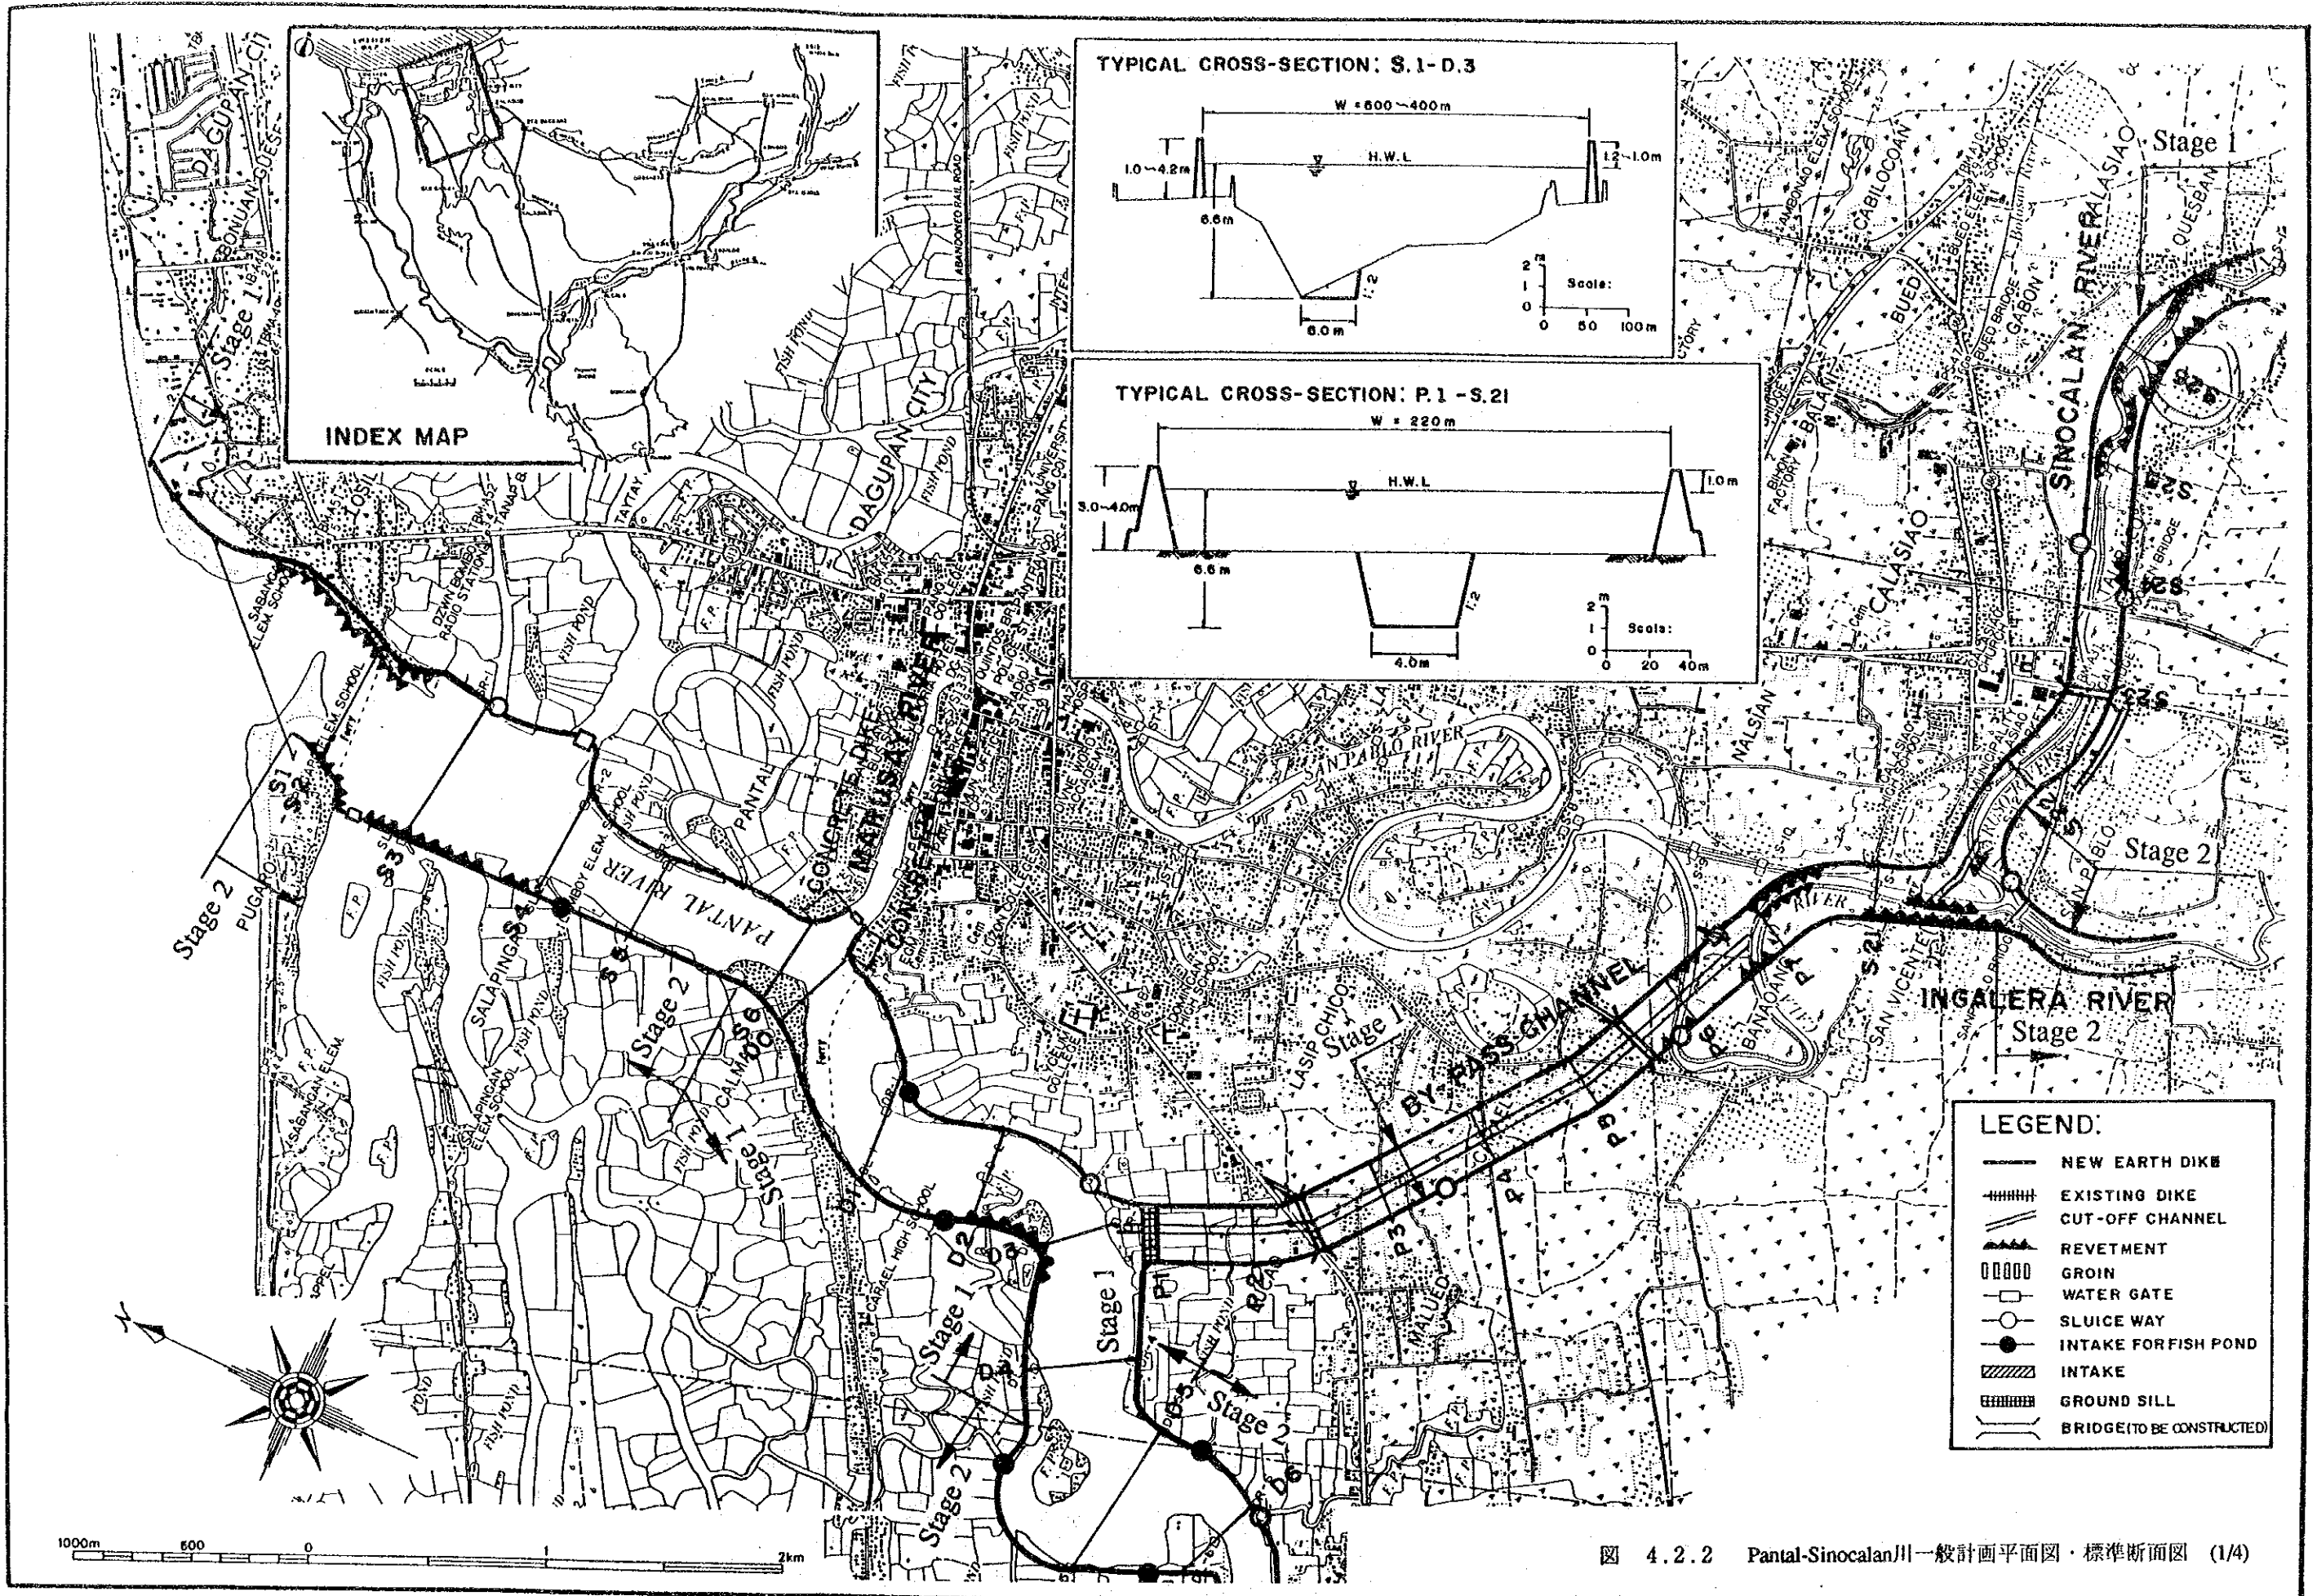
Pantal-Sinocalan川一般計画平面図・標準断面図 (1/4)
